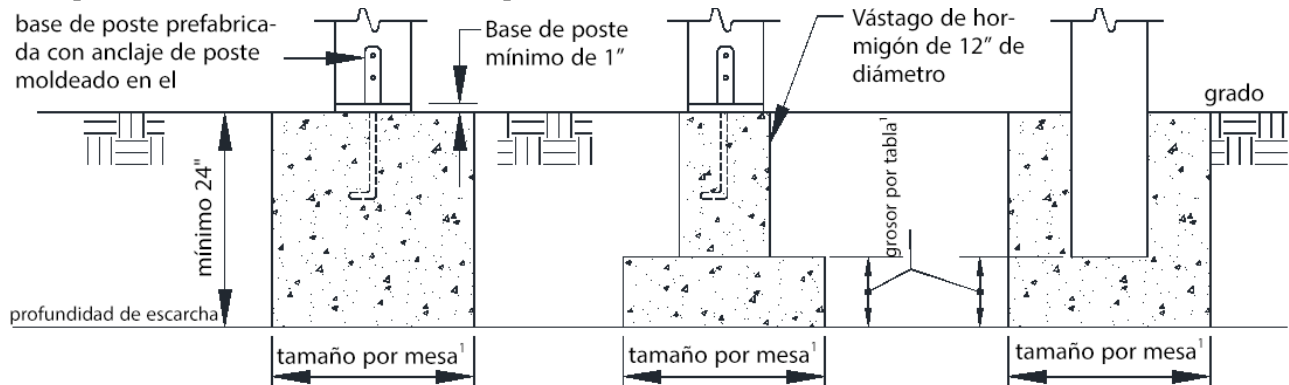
ZAPATAS ADYACENTES A CASA EXISTENTE
